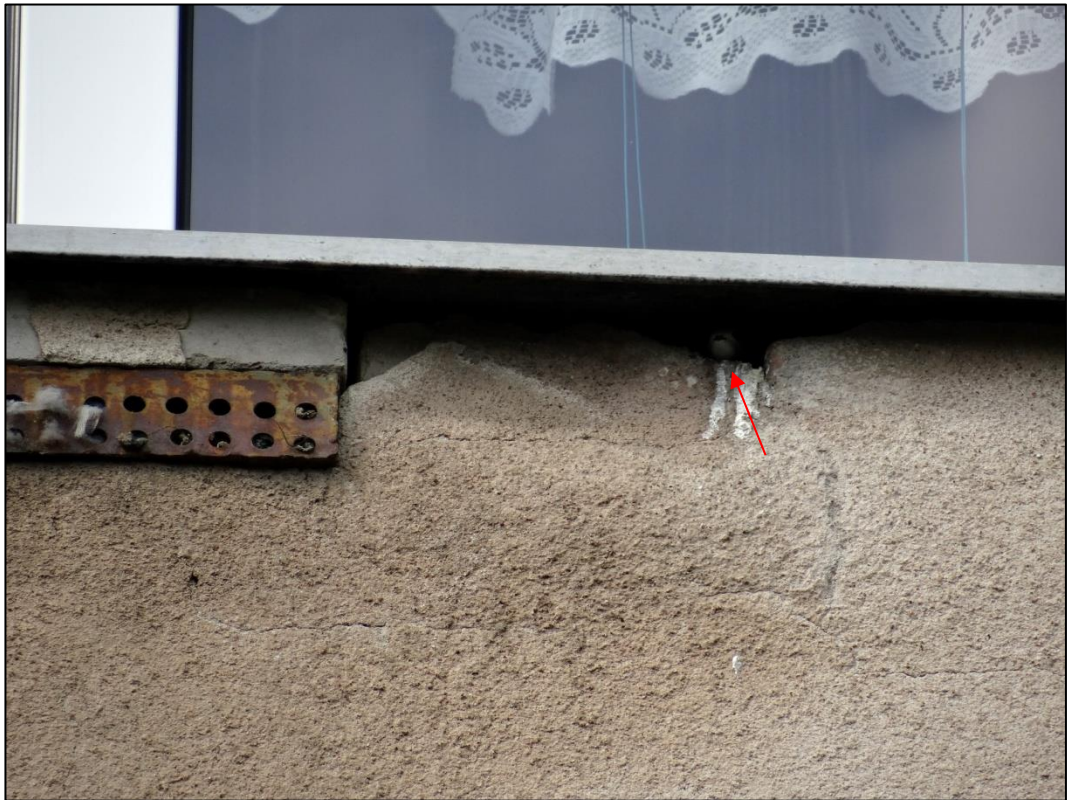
Szkoła Podstawowa w Garbnie – elewacja główna (strona lewa) cz. B.
